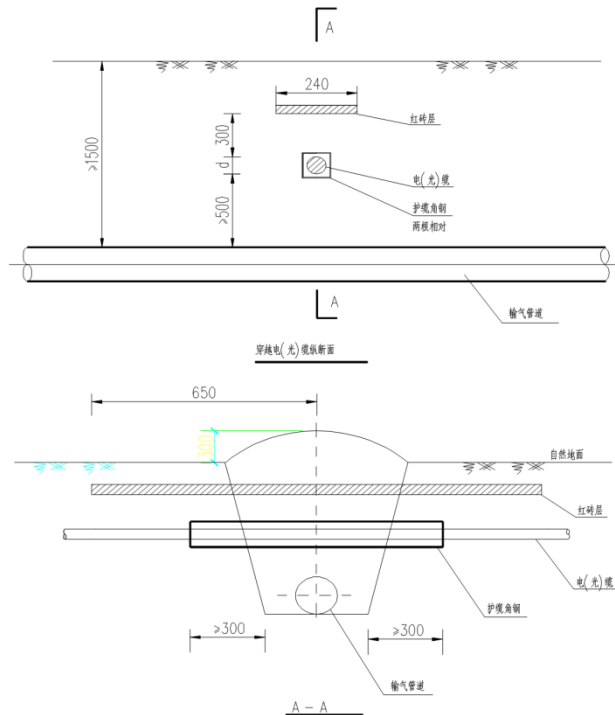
已建地下电缆、光缆穿越施工示意图
